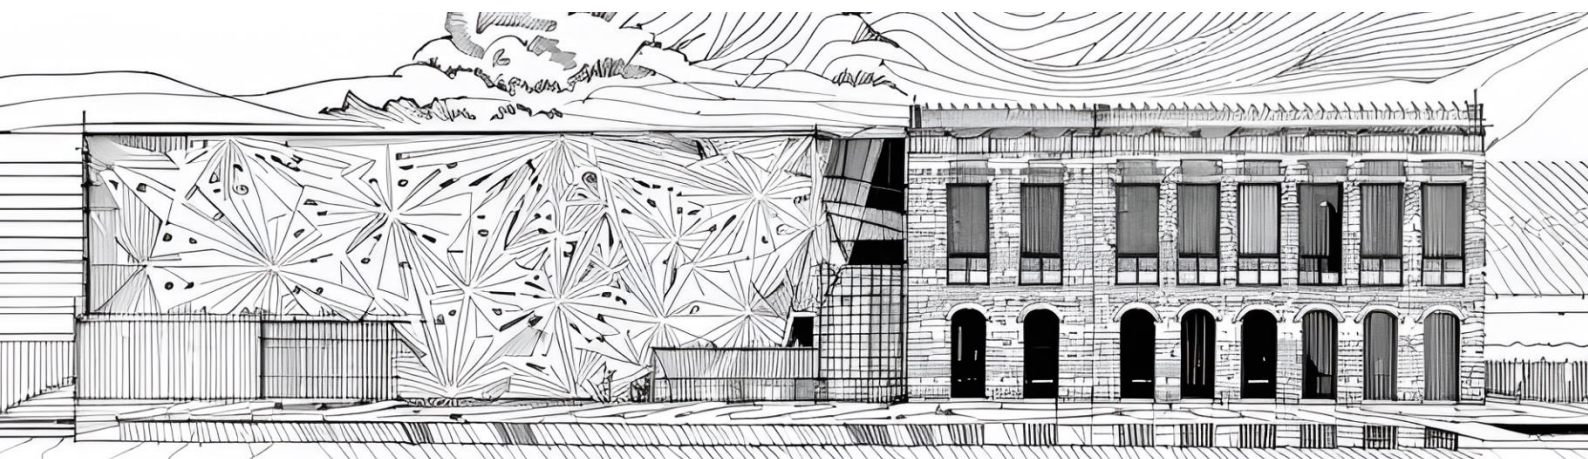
Perspectiva da fachada, Fonte: Elaboração autoral, 2023
